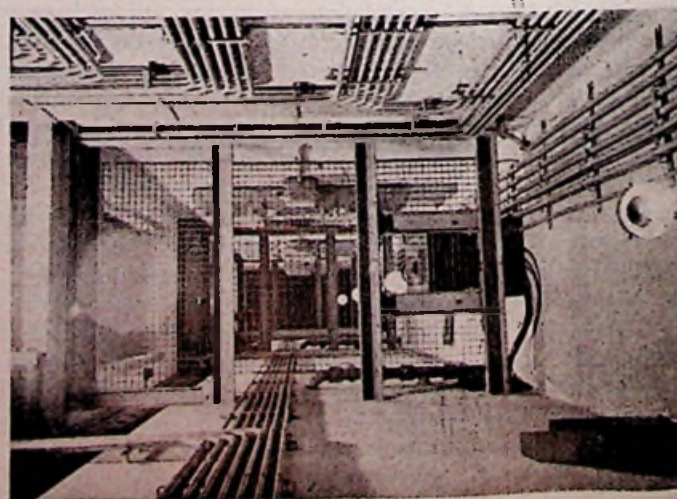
Detail van een leidingtunnel in de gang van een kantoorgebouw
